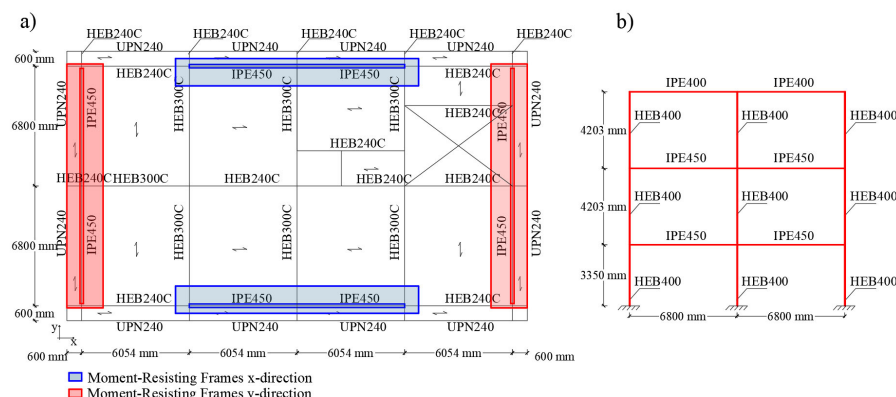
Viste in pianta (a) ed in elevazione (b) dell'edificio
